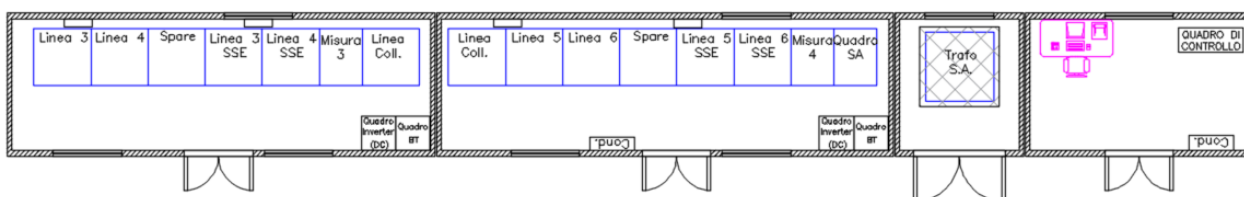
Quadro di Raccolta e Misura: Zona 2, Planimetria
